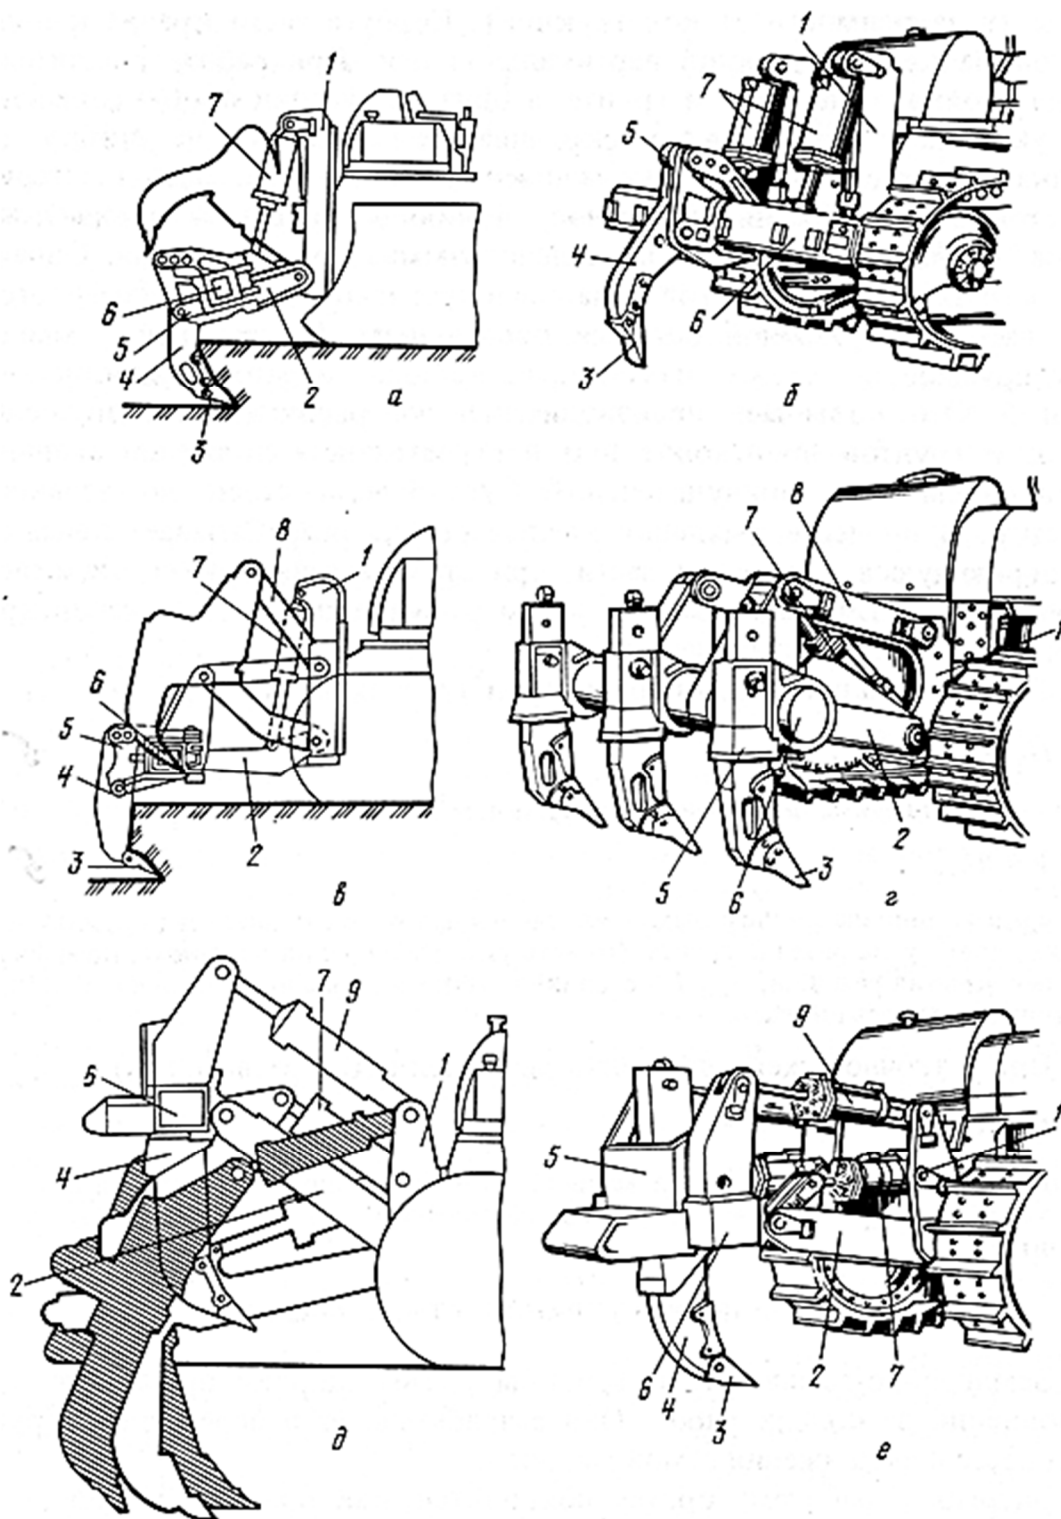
Схеми та загальний вид розпушувачів:
